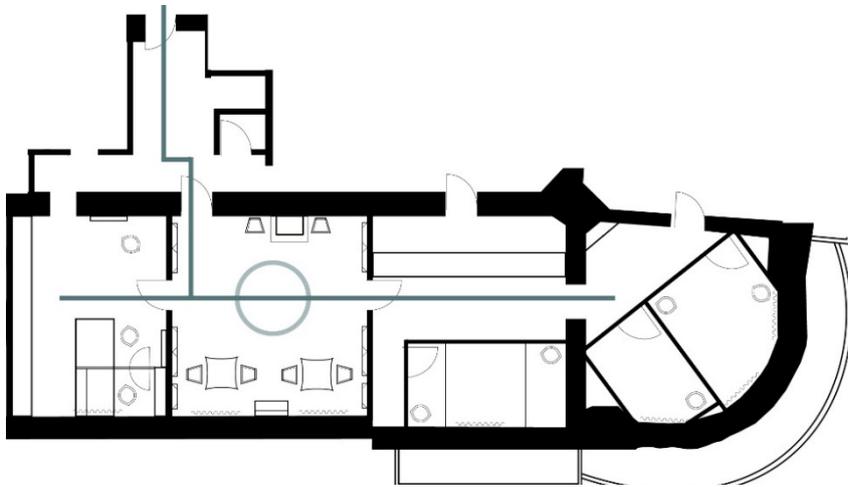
Grundriss des Modesalons mit linearer Wegeföhrung und dem Zentrum „Empfangssaal“
